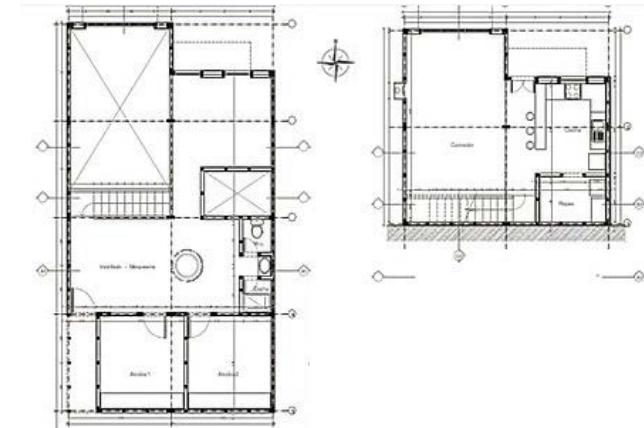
[Figura] Plantas casa Santander. Fuente: Bahareque construcciones
